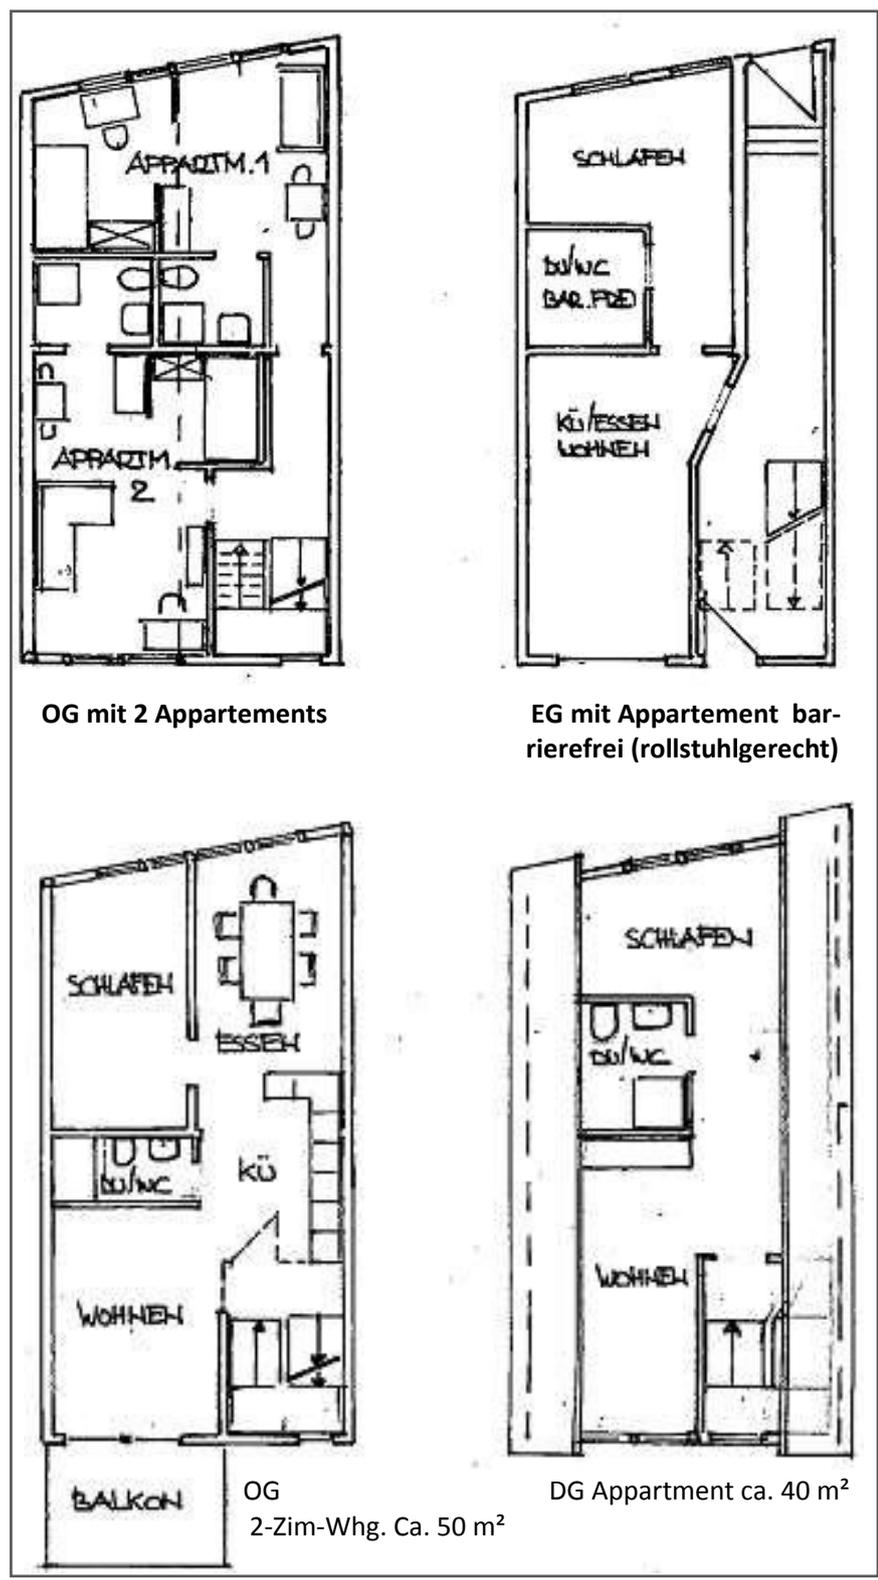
mögliche Grundrisse (akp_ / G. Armbröster)
